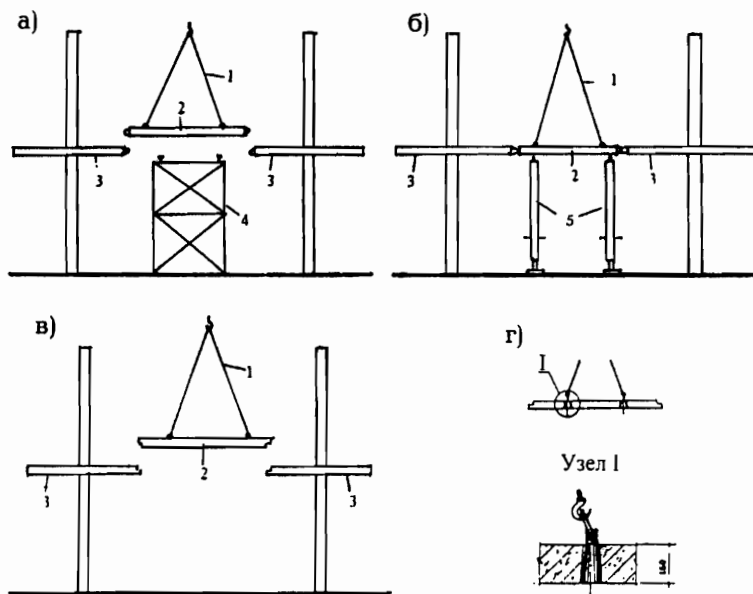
Монтаж межколонных плит: а – с временным опиранием на переносные подмости; б – с опиранием на выдвижные опоры; в – с опиранием на надколонные плиты со стыковкой «в четверть»; г – вариант строповки за отверстие в плите; 1 – четырехветвевая строп; 2 – межколонная плита; 3 – надколонная плита; 4 – временная опора с установочными винтовыми домкратами; 5 – трубчатые винтовые опоры
